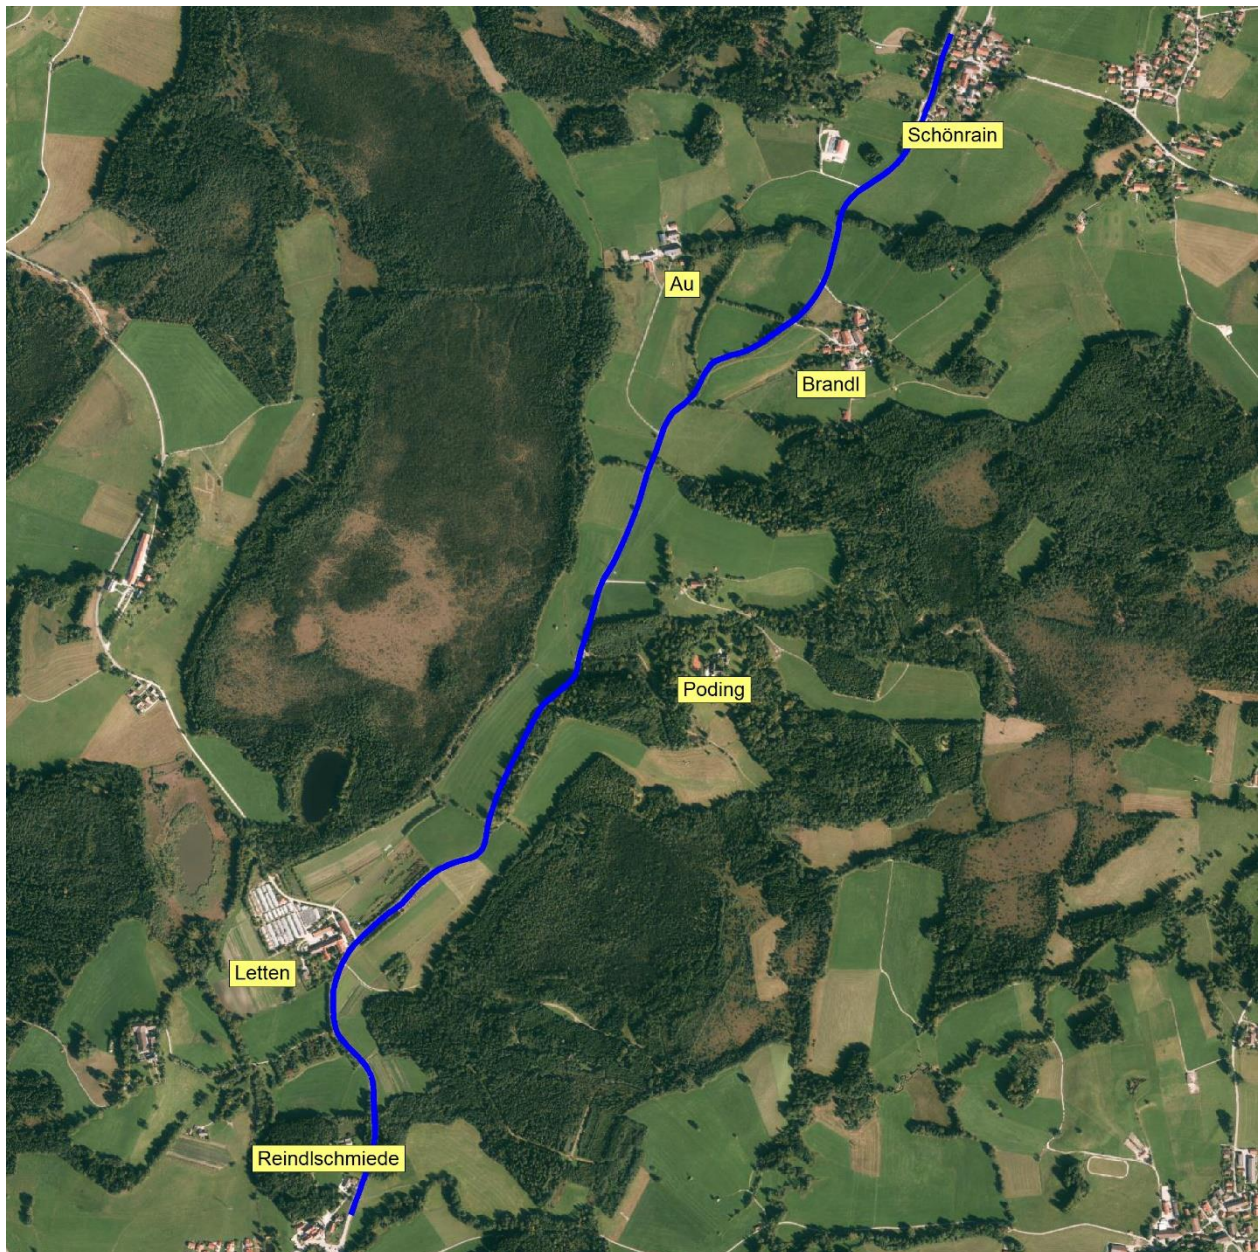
Übersichtslageplan, Bestand, Quelle: Bayerische Vermessungsverwaltung, genordet
